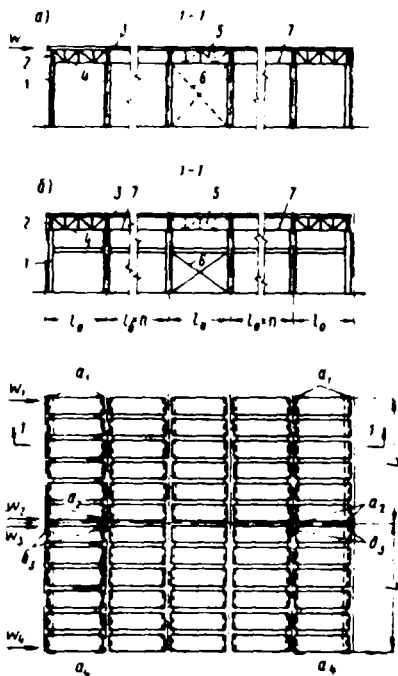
Расчетные схемы (4 и 5) диска покрытия и связей зданий с плоской кровлей (обозначения те же, что на рис. 2.14)
